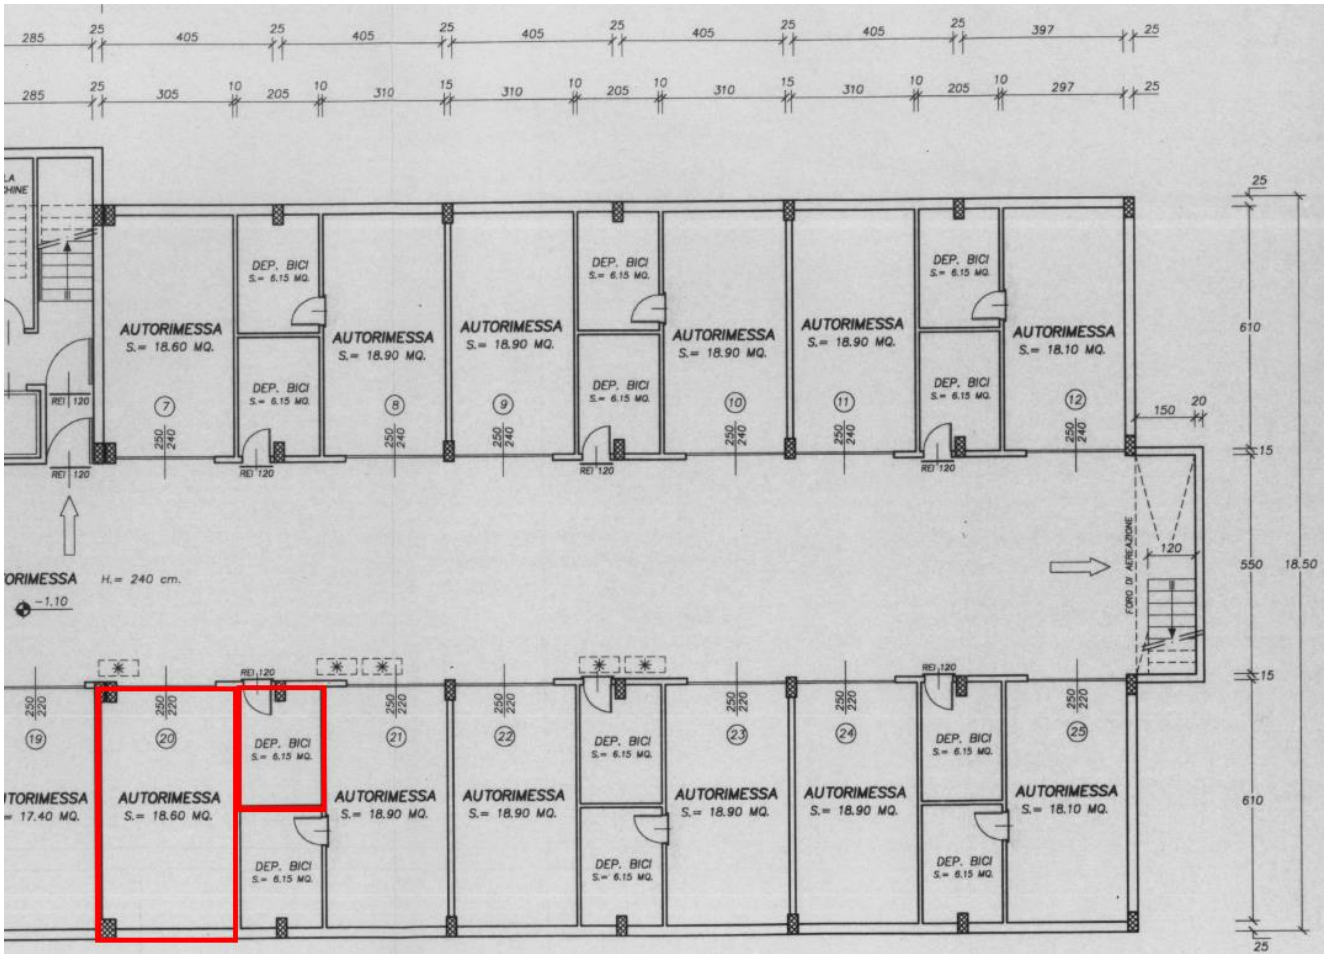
planimetria piano interrato Autorimessa sub 23 cantina sub 49- fuori scala
